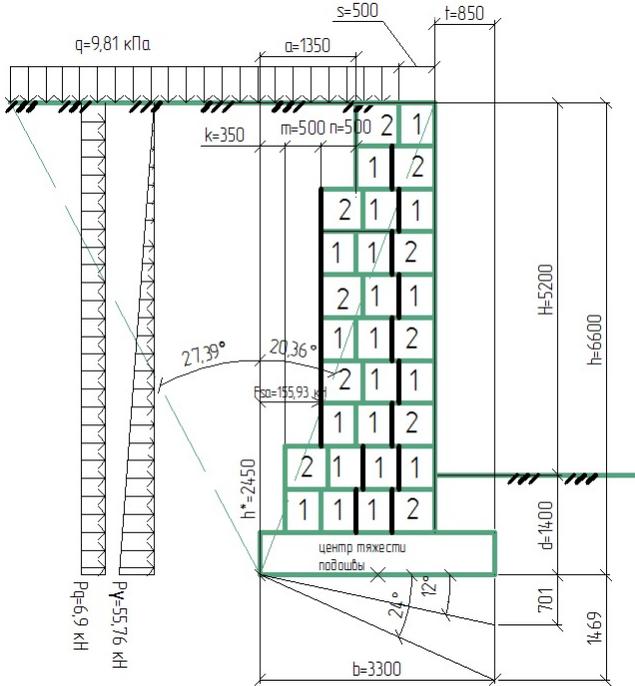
Расчетная схема устойчивости стены против сдвига
